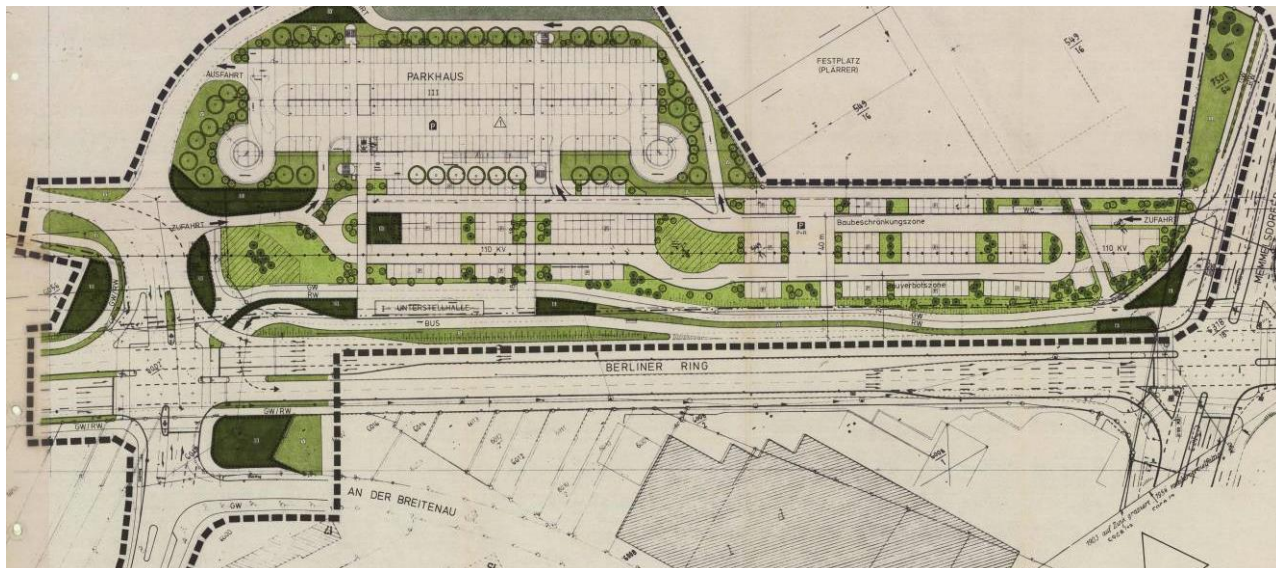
Ausschnitt – Grünordnungsplan zum Bebauungsplan Nr. K 3 A 1997
